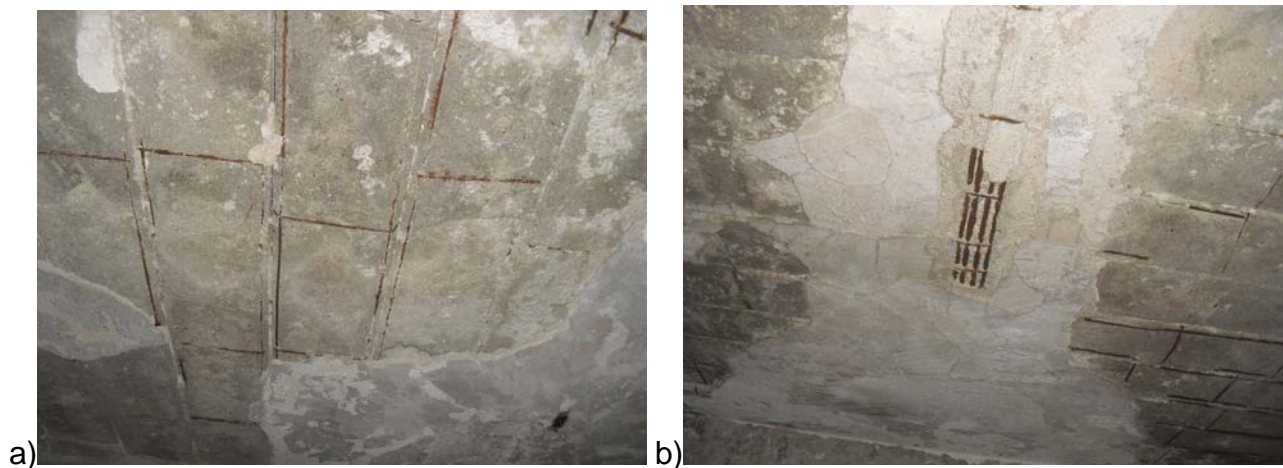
Degrado strutture orizzontali : a) solai; b) travi.
